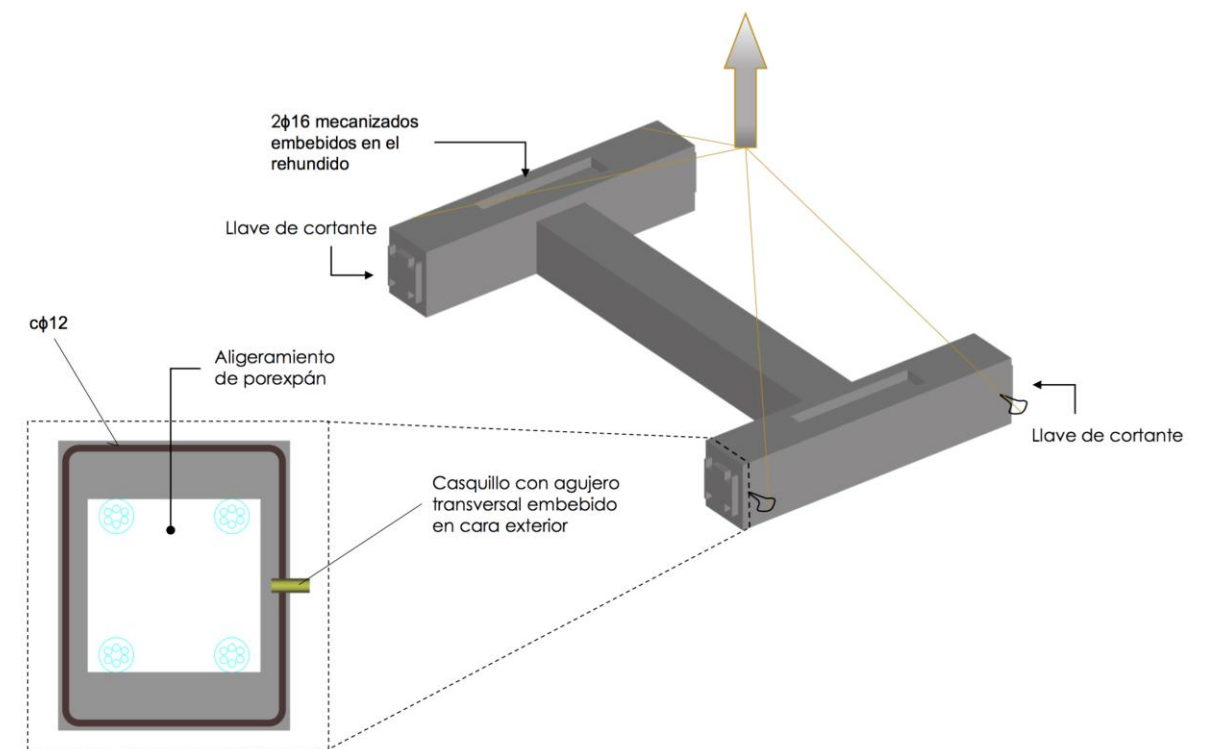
Izado y detalles constructivos de elementos centrales del tablero
